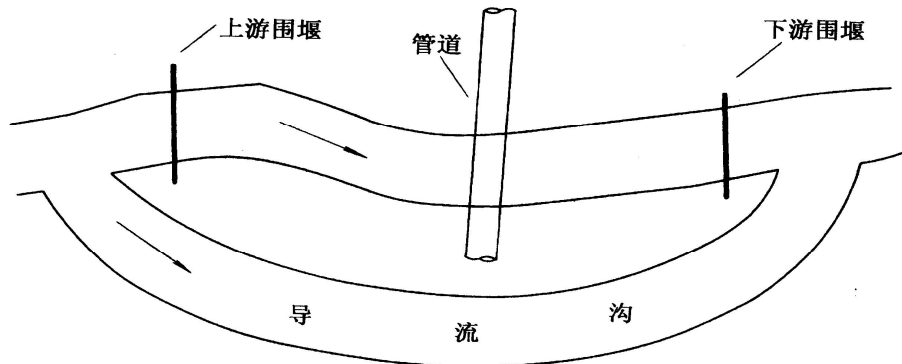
围堰导流开挖管沟穿越小型河流断面示意图
